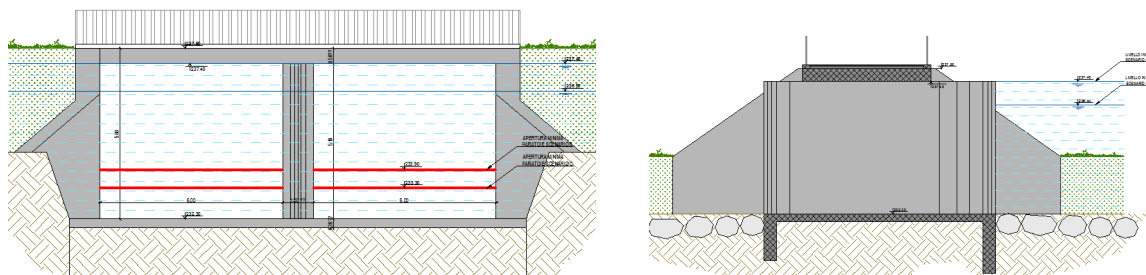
Prospetto e sezione trasversale dell'organo di regolazione.
